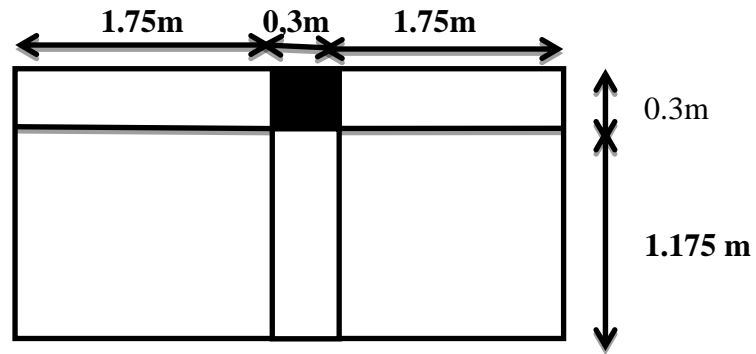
Dimension de la section revenant au poteau (H-10).
